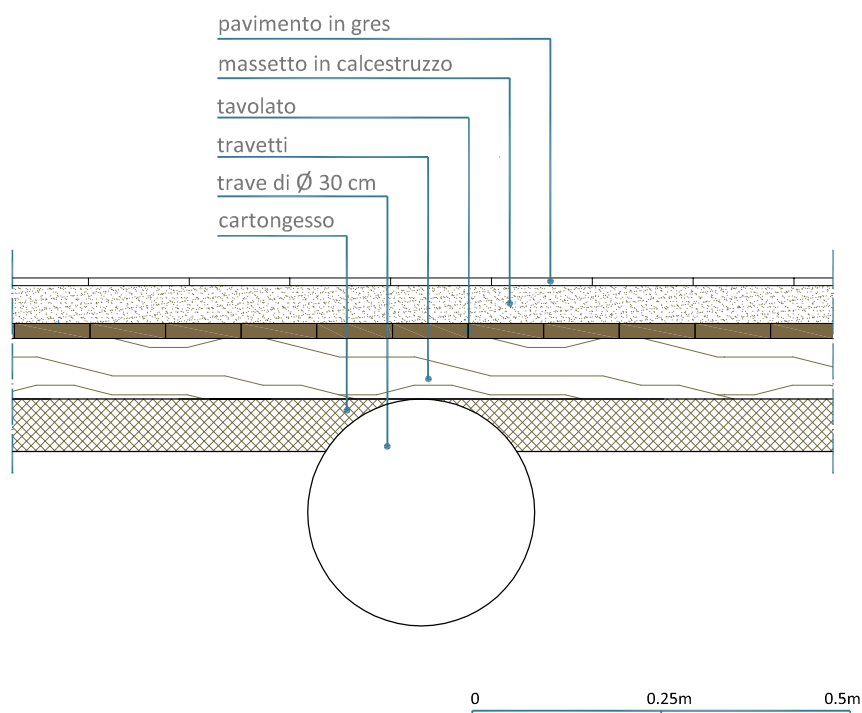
Particolare del solaio corrispondente all'intervento tipo 2.
